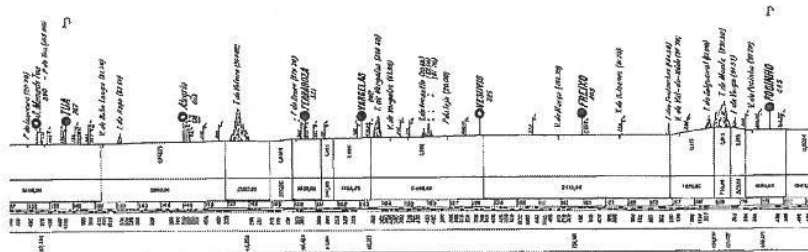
Perfil longitudinal entre Tua e Pocinho
